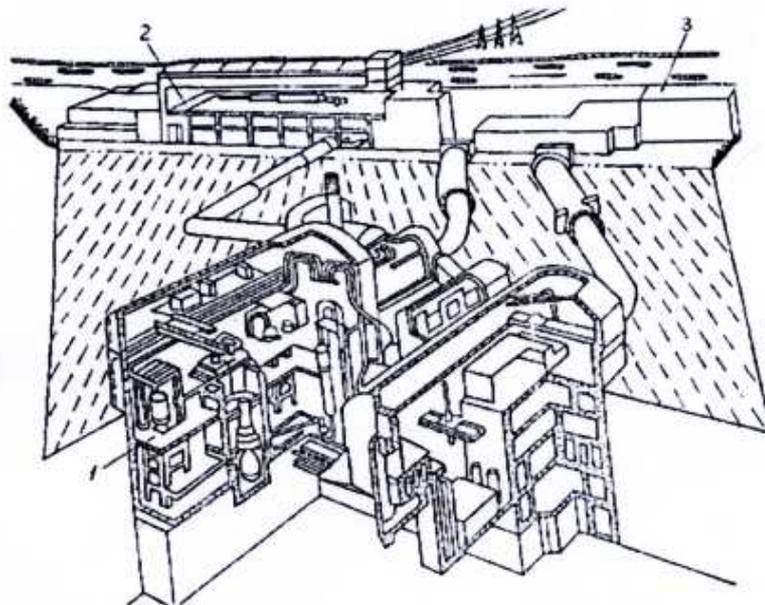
Подземная АЭС "Сена-Чуз": 1 – выработки реакторного помещения; 2 – выработки электротехнического оборудования; 3 – помещения вспомогательных систем
